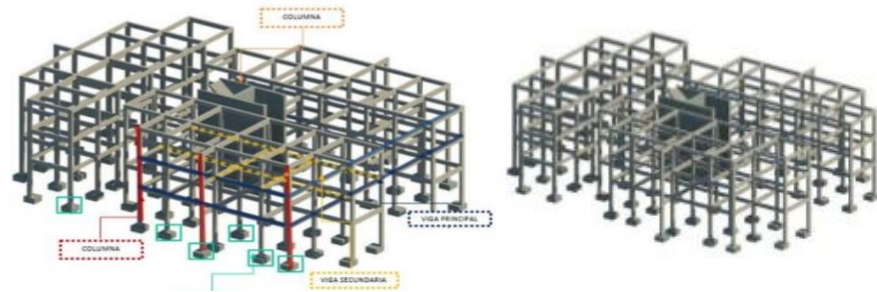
Sistema a porticado. Fuente: Chuquimia, L. (2017)
